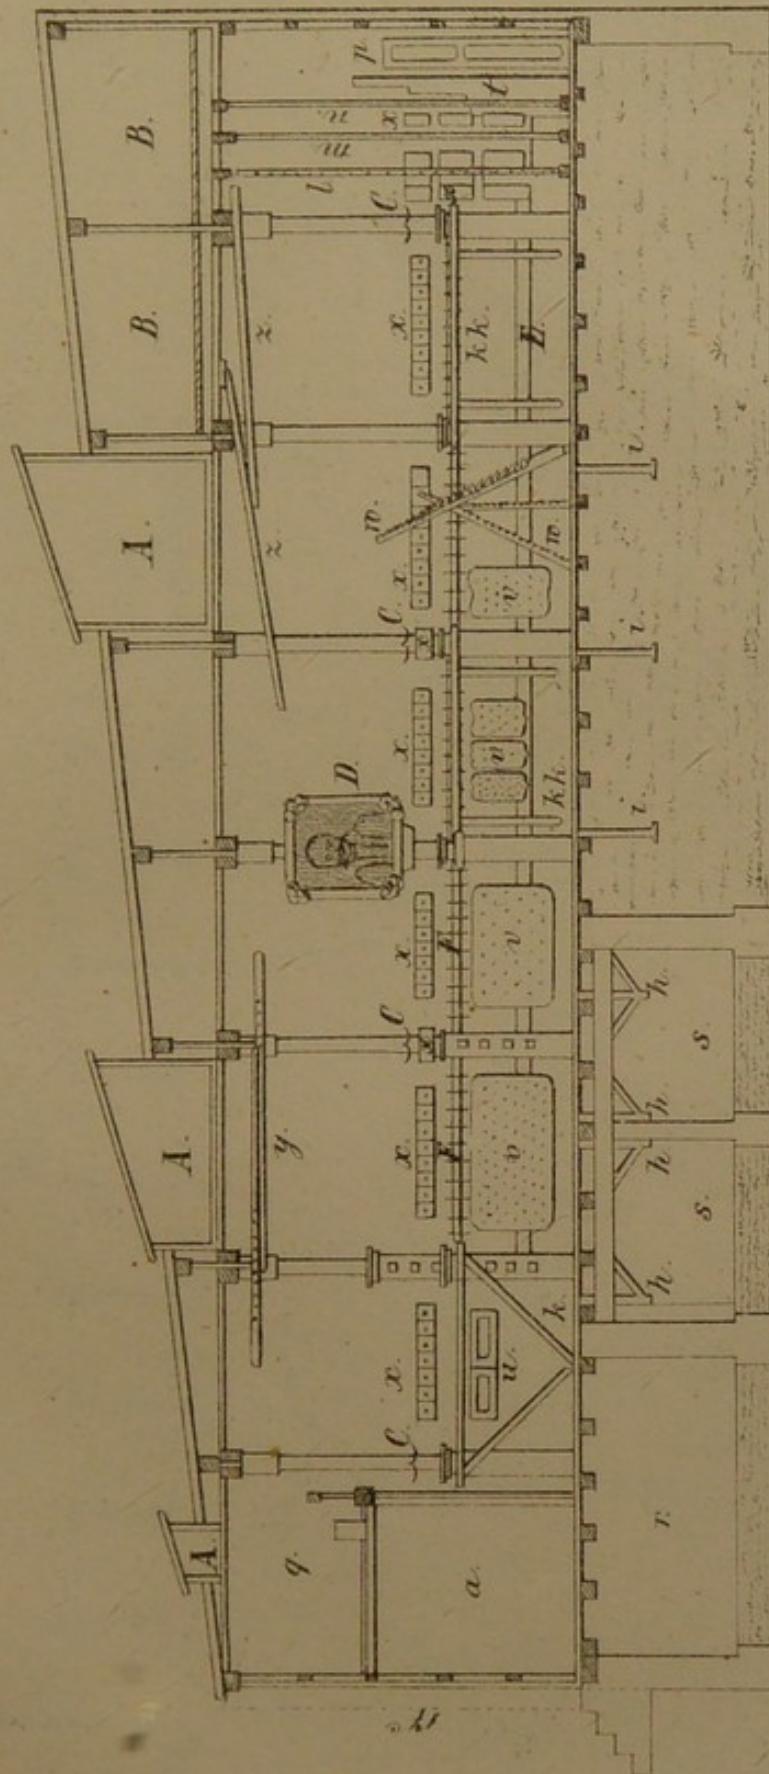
Grundriss des Kluge'schen Turnhauses.
